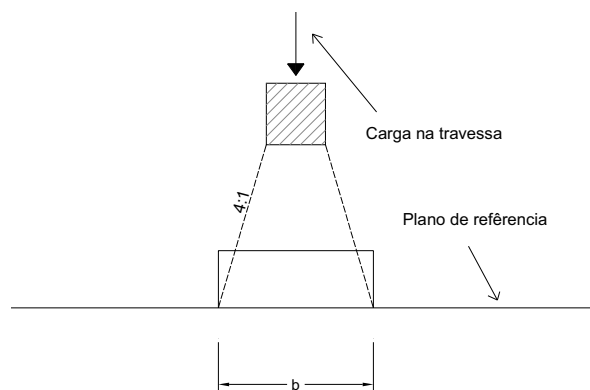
Distribuição longitudinal da carga pela travessa e pelo balastro
